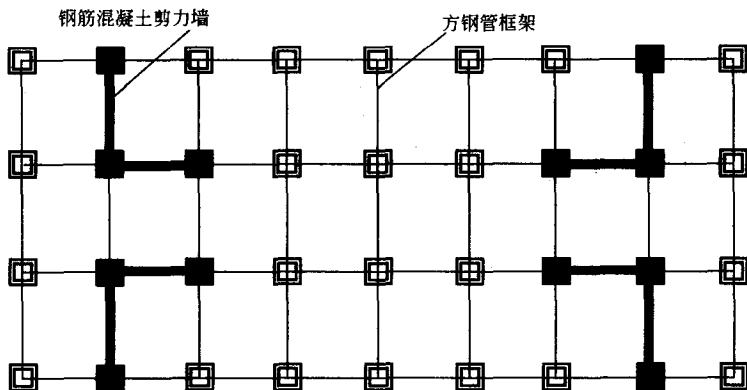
方钢管框架-钢筋混凝土剪力墙高层混合结构平面示意图
